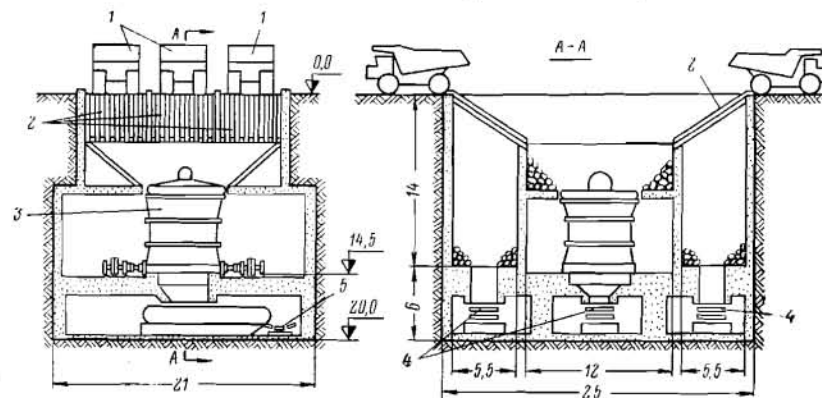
Перегрузочный узел с грохотильно-дробильной установкой: 1 — автосамосвалы; 2 — грохоты; 3 — дробилка; 4 — перегрузочное устройство для подгрохотного материала; 5 — конвейеры
